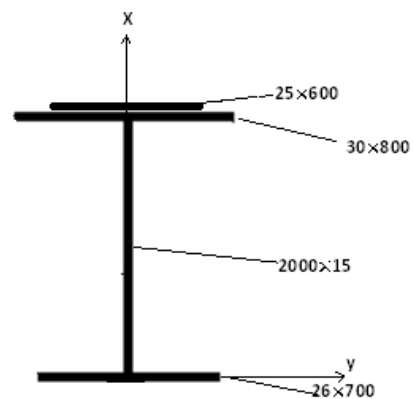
Coupe de la nouvelle section d'acier.
